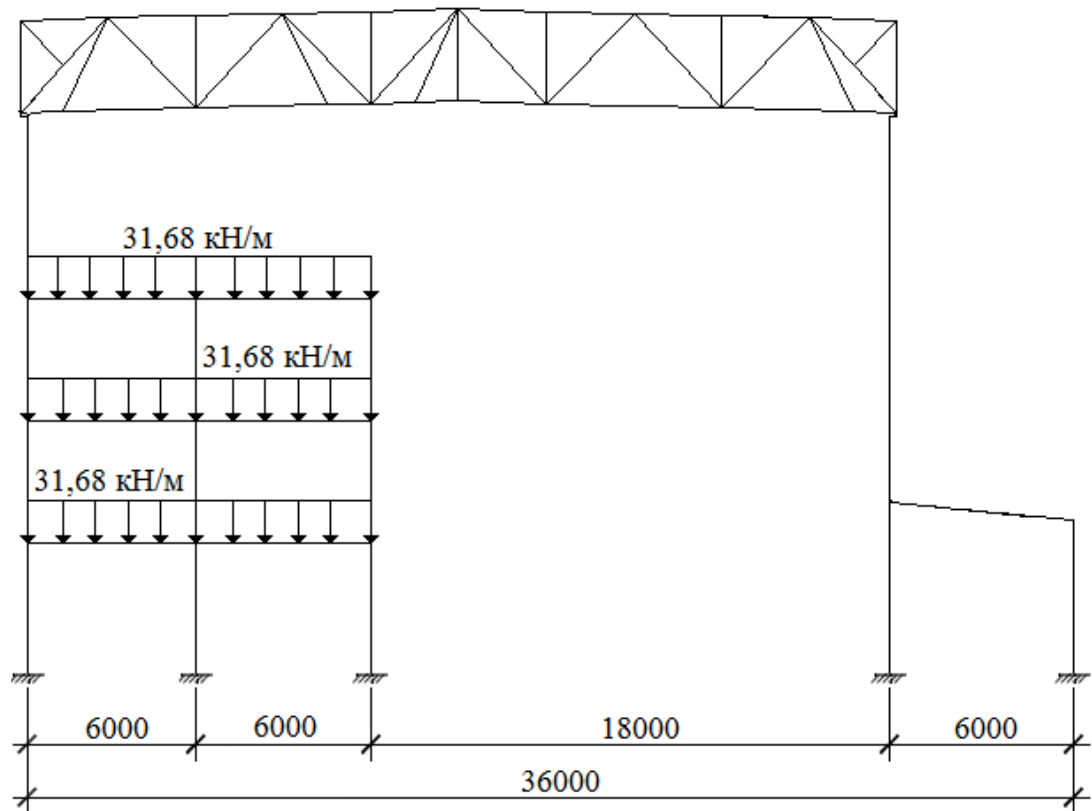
Схема загрузки от временной нагрузки на перекрытие
